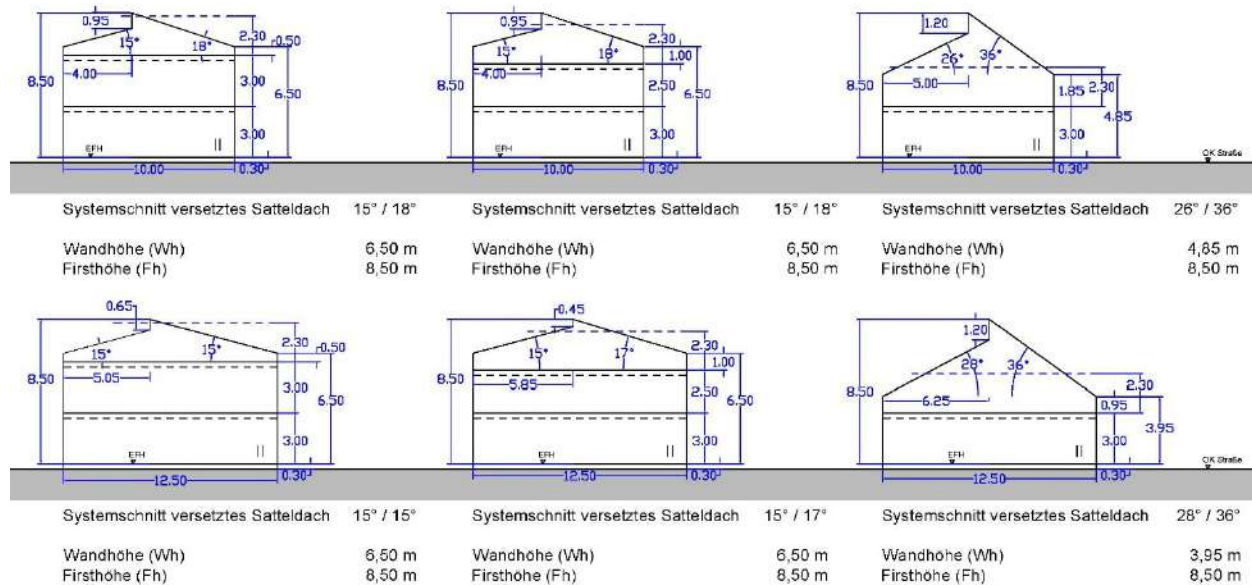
Systemschnitte Gebäude mit Satteldach, (GH 8,50 m, DN 15°- 48°), ohne Maßstab
